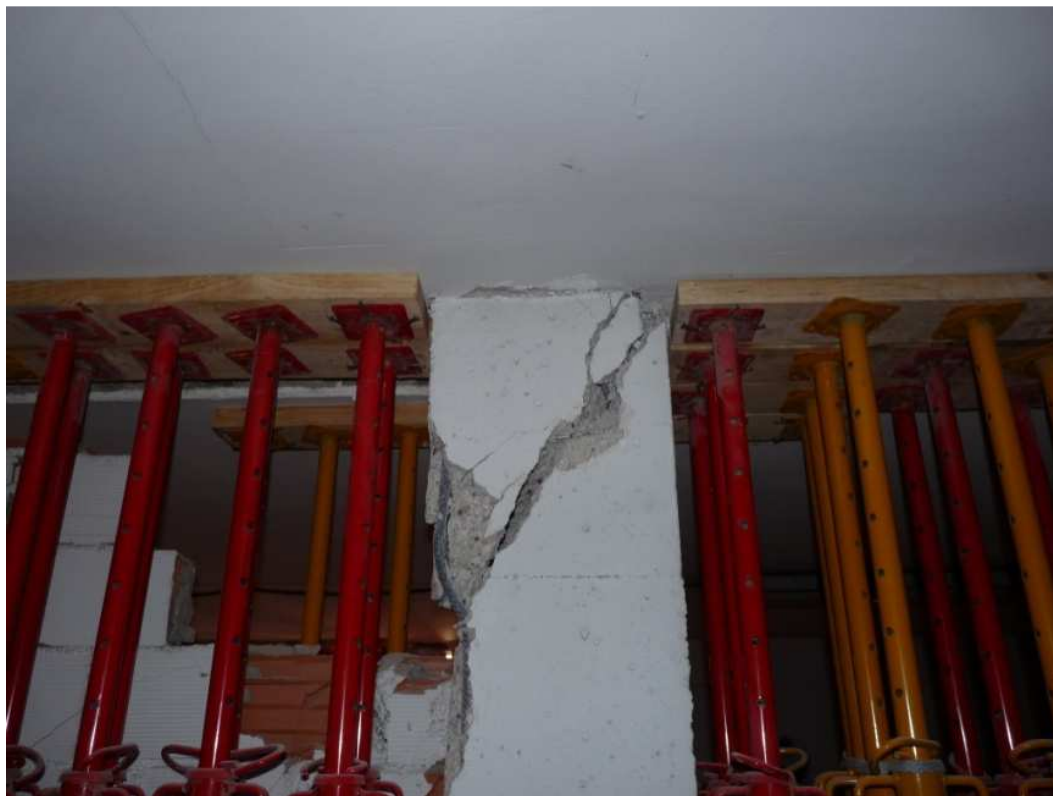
Rotura de cabeza de pilar con deformaciones en la armadura.
